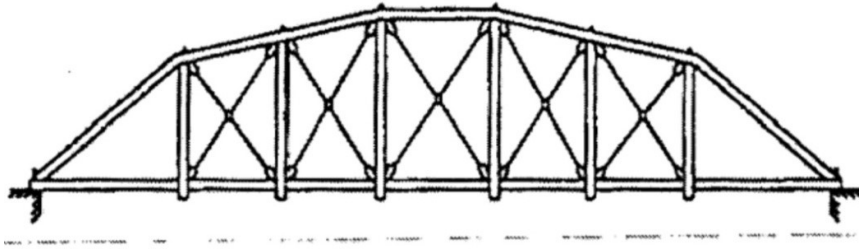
Jembatan rangka baja tipe *Howe
